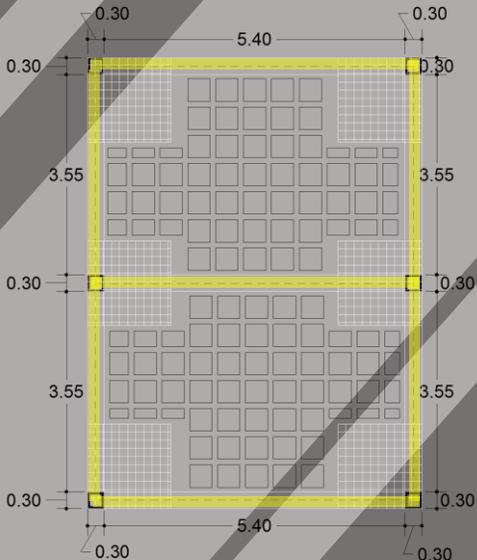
Trabes TC2 en losa reticular de entrepiso.
